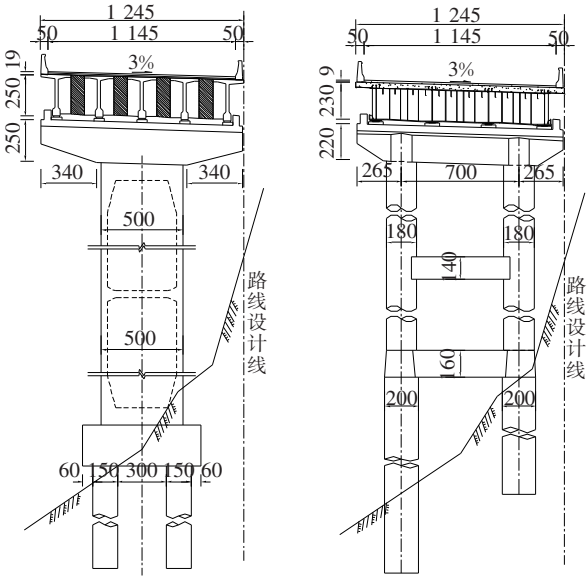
预应力混凝土 T 梁和钢混组合梁方案剖面图(单位:cm)
